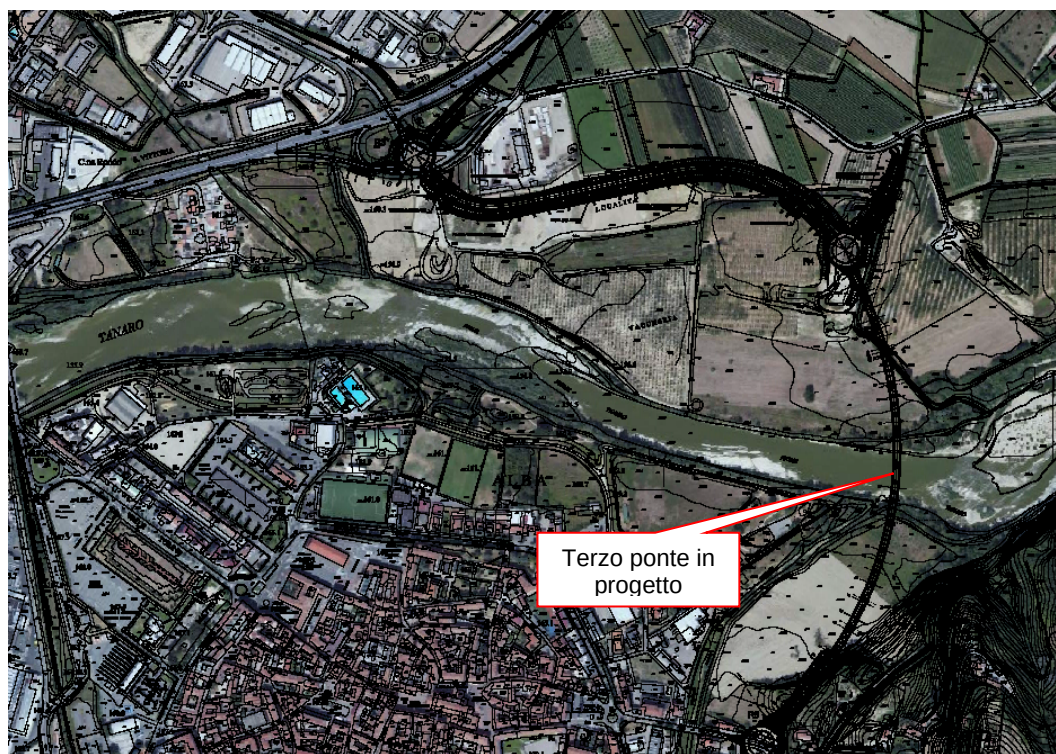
planimetria su foto aerea del terzo ponte in progetto sul Fiume Tanaro.
